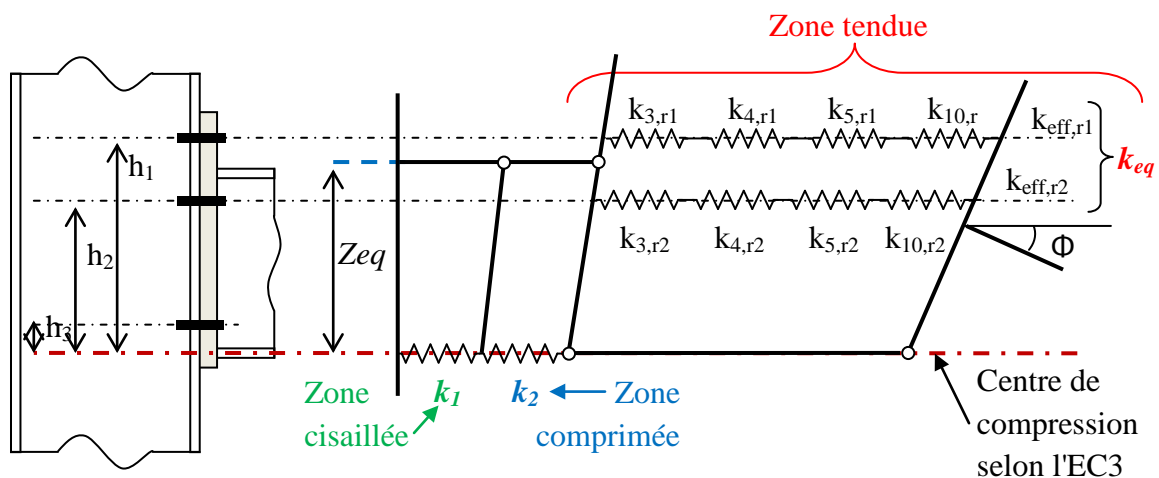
Rigidité d'un assemblage par platine d'about.
